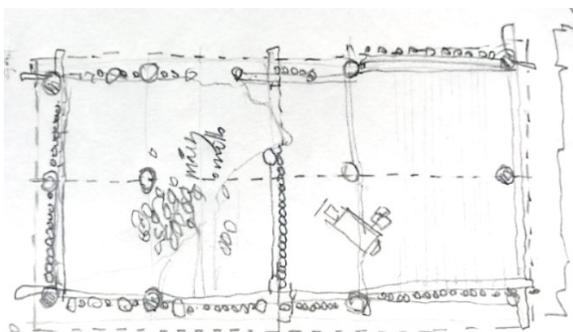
Planta de troja en madera y cañabrava, caso 8. Figura 180. Troja con entresuelo ventilado.
